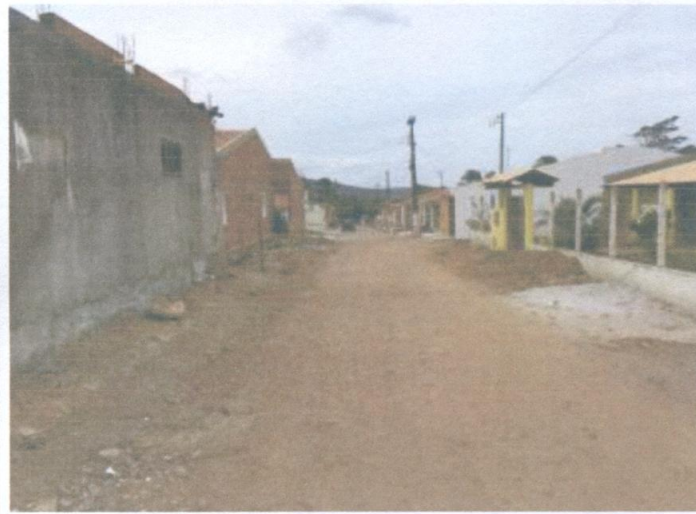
FOTO VISTA DA RUA B VISTA DA RODOVIA ATÁ A ESCA E-0
